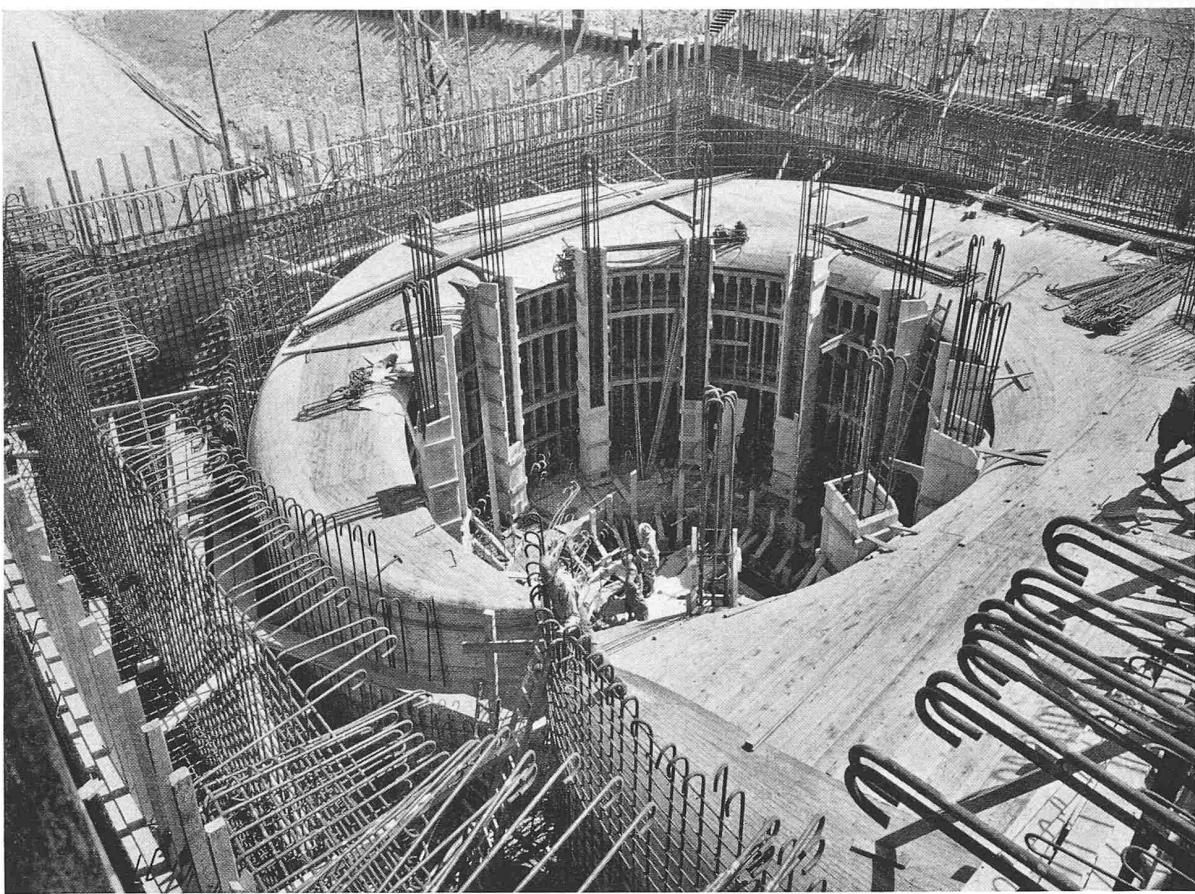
Maschinenhaus. Schalung der Einlaufspirale für Maschinengruppe 2. 23. August 1950
